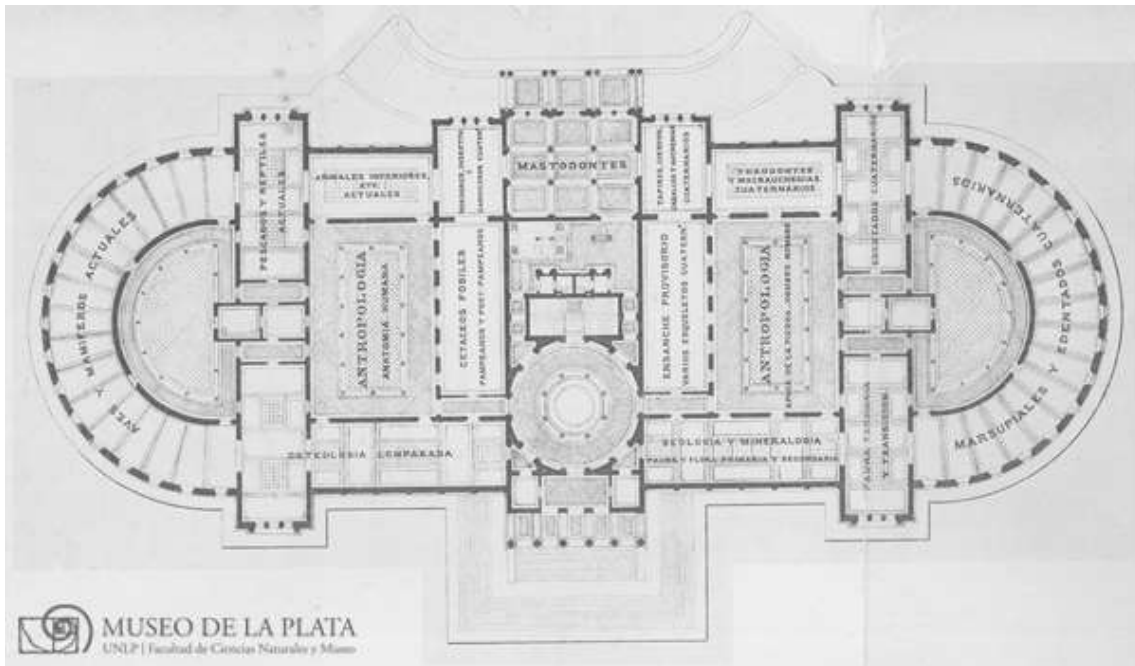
Plano de Planta del Edificio del Museo. Archivo MLP
